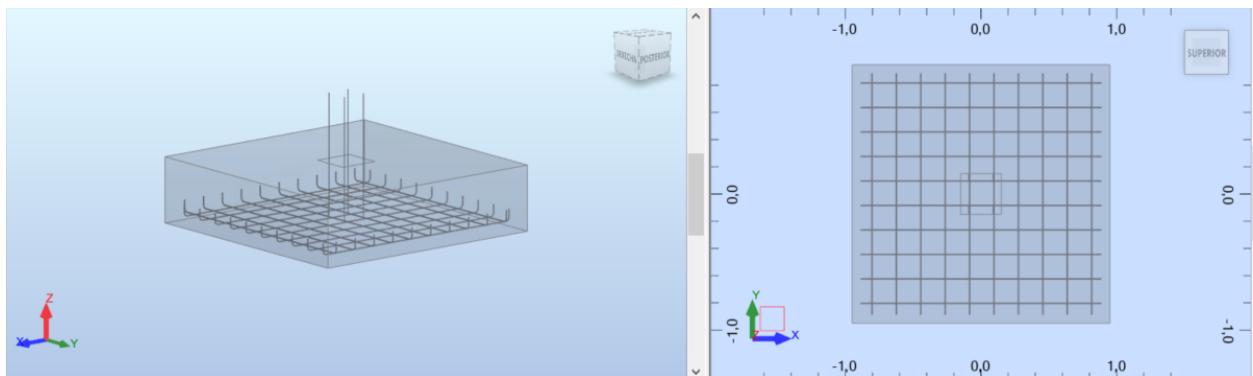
Vista 3D de la armadura para zapata aislada
